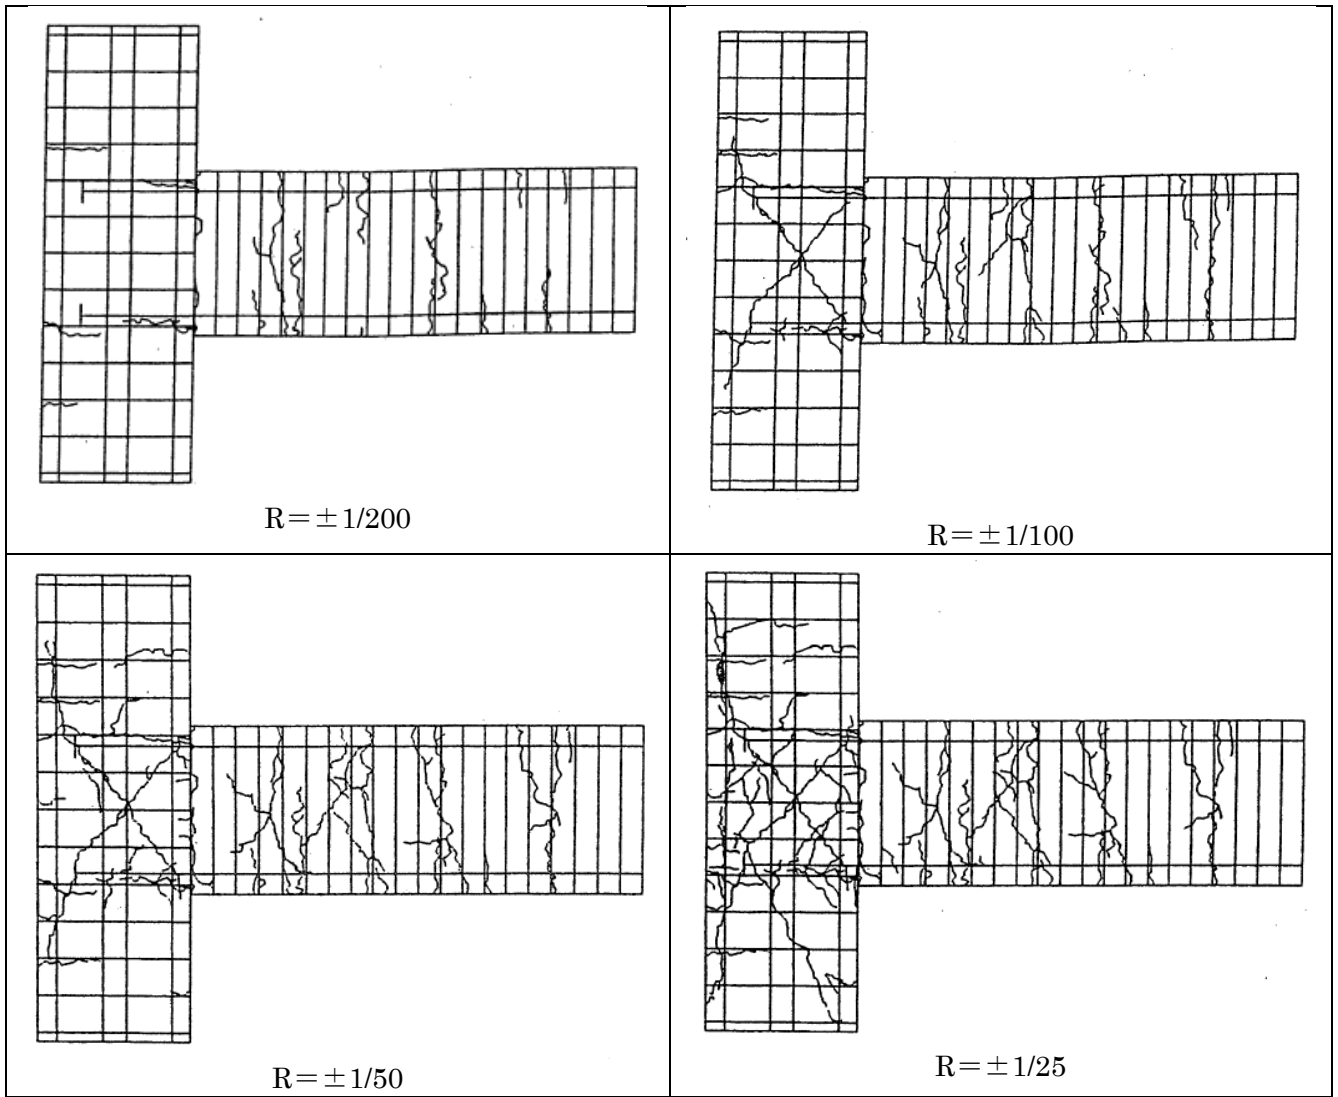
4. 1999No.7 試験体ひび割れ図
